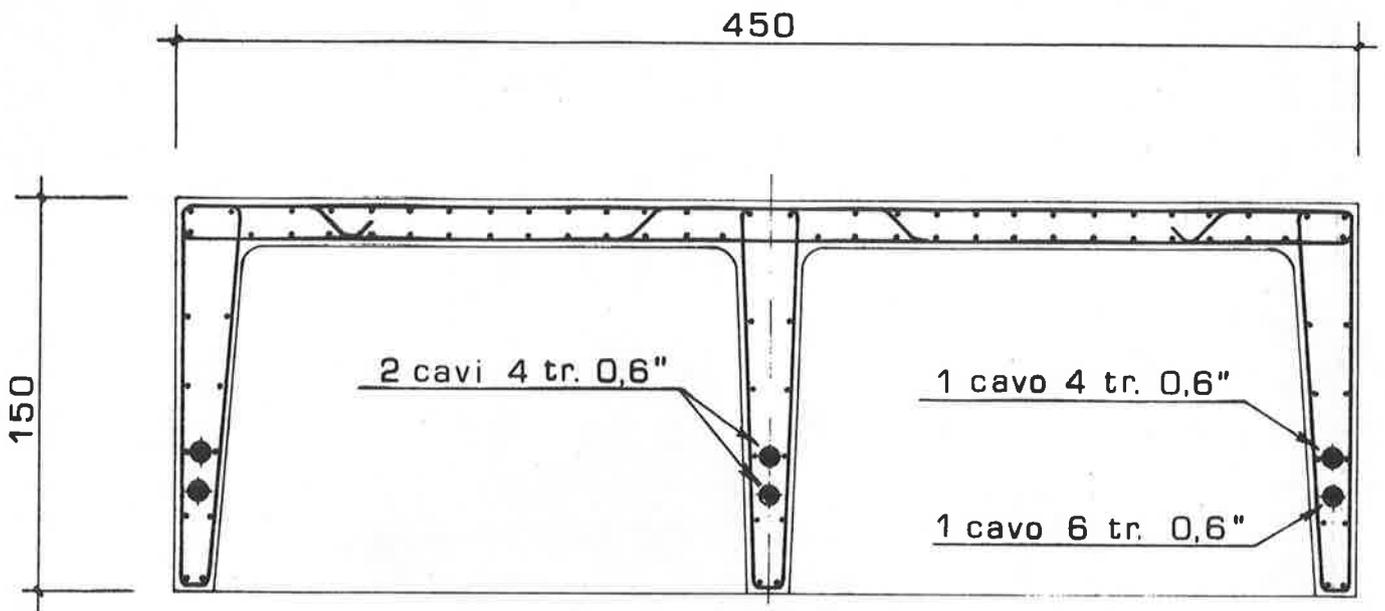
Pontile RUMIANCA - Sezione dell'impalcato prefabbricato precompresso
